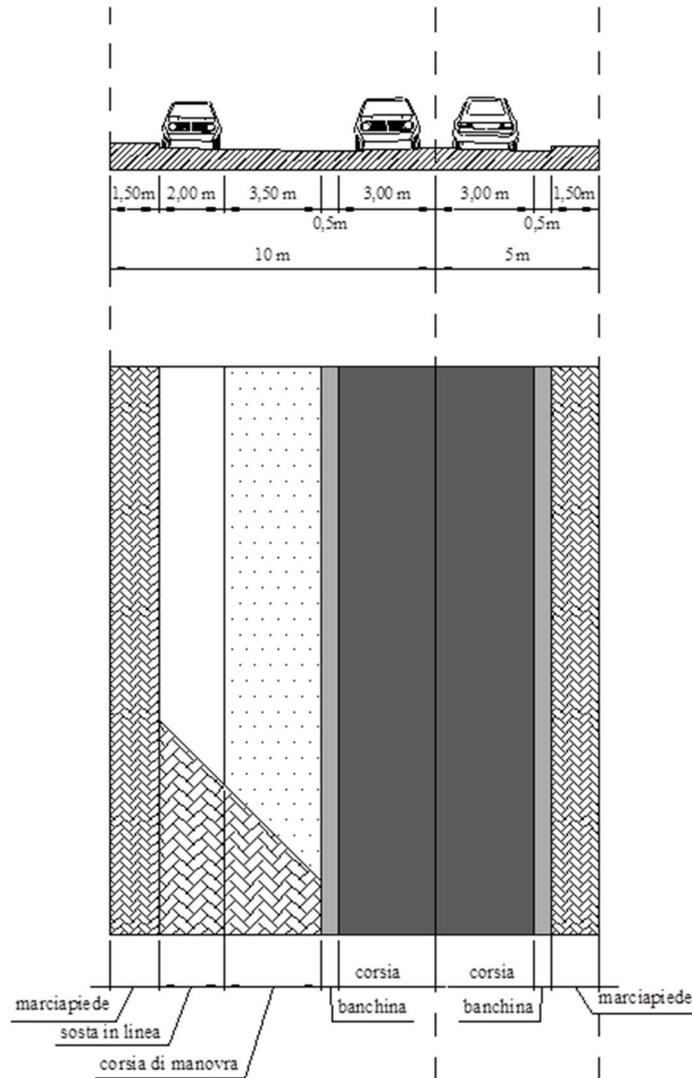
Sezione Tipo Strada di Interquartiere e Strada di Quartiere (E)
